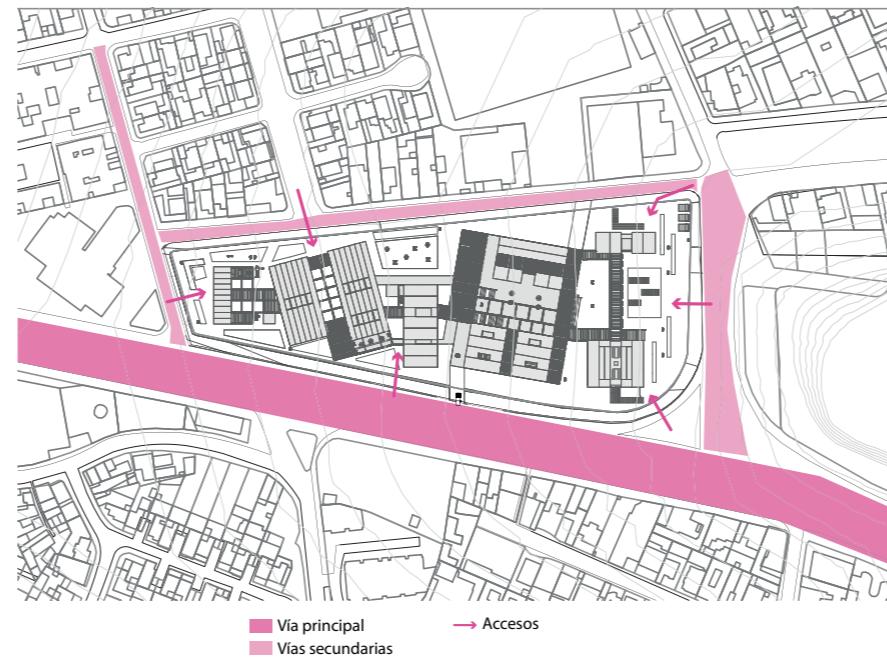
Accesos al proyecto. Elaboración propia(2025).
